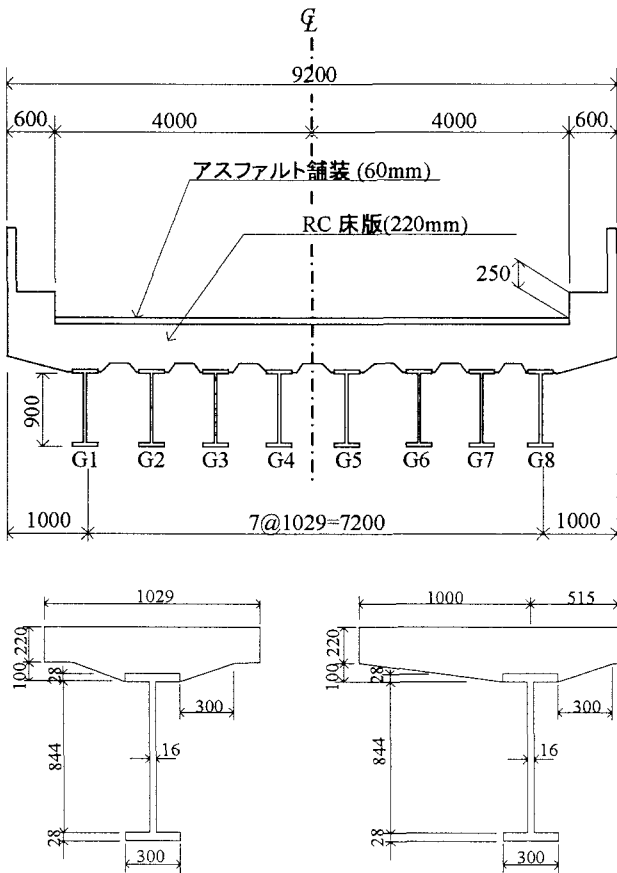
H 形鋼桁橋モデルの横断面図（主桁 8 本）
